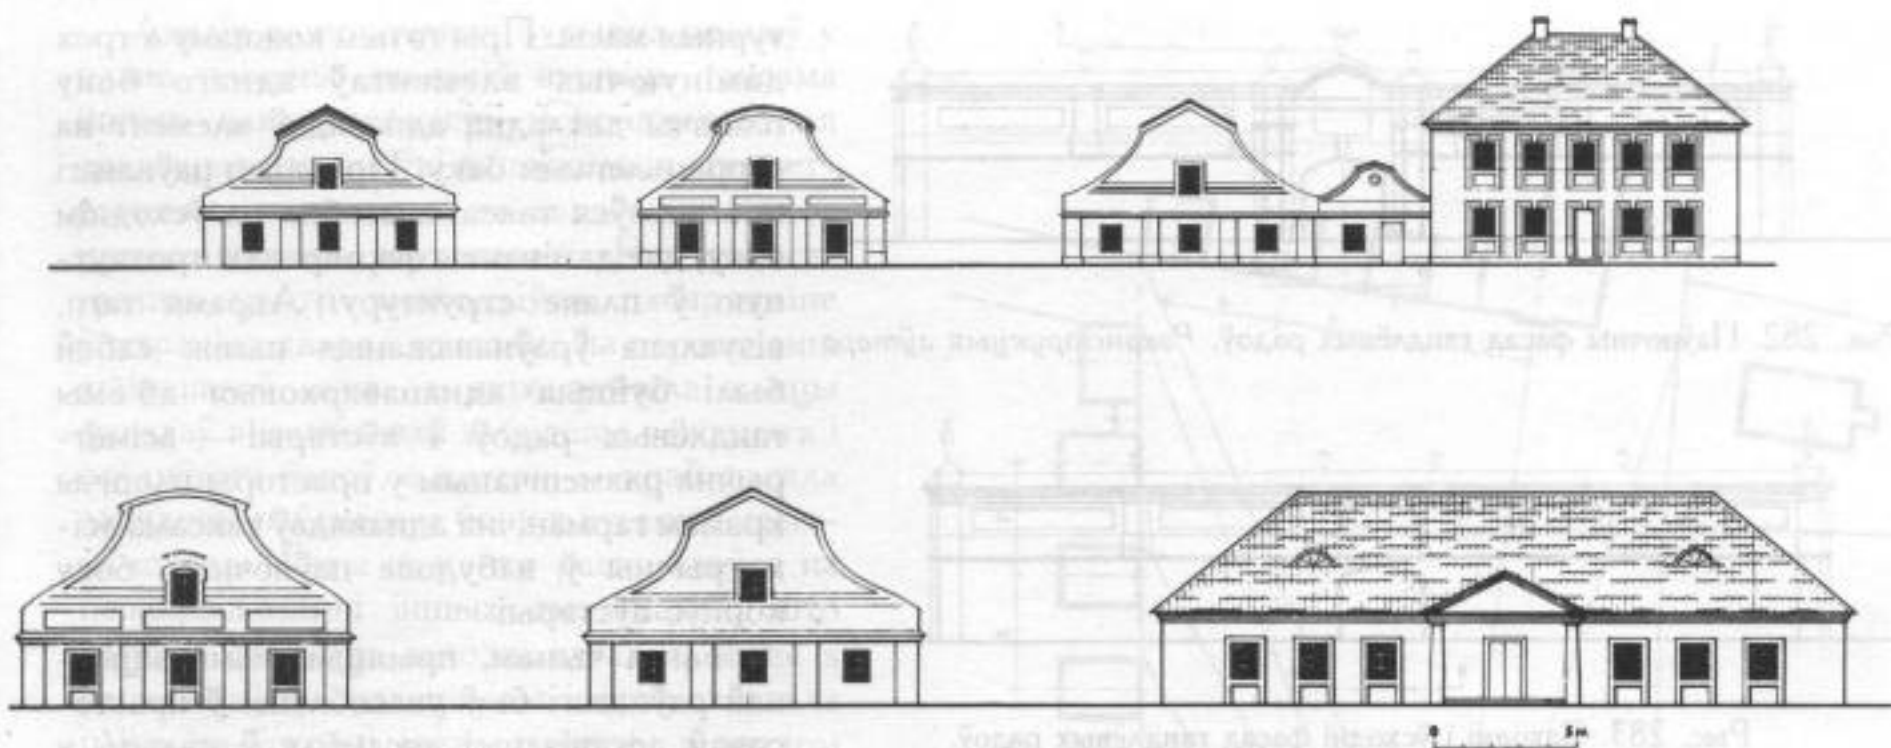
Фасад забудовы паўночнага боку плошчы. Рэканструкцыя аўтара
